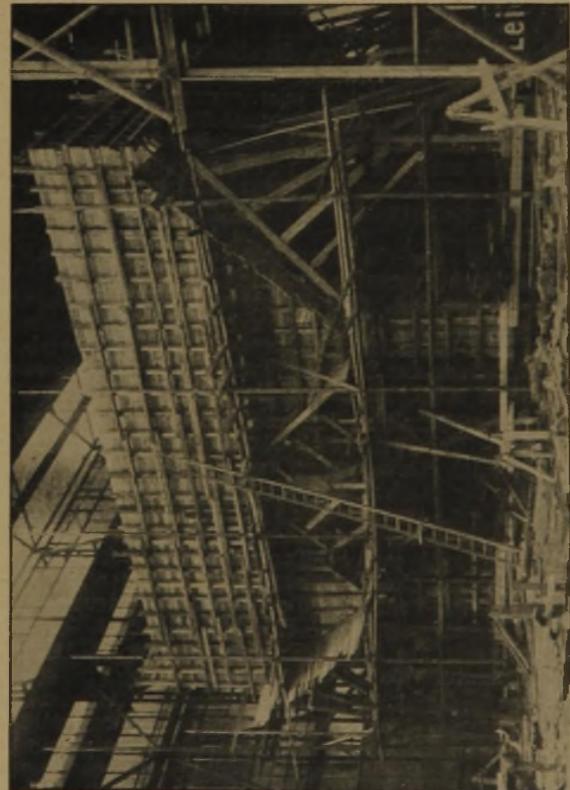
Bochumer Verein. Erz- und Dolomit-Bunker. Einrüstung zur Betonierung. Eisenbetonbauten für die Lagerung von Massengütern.
